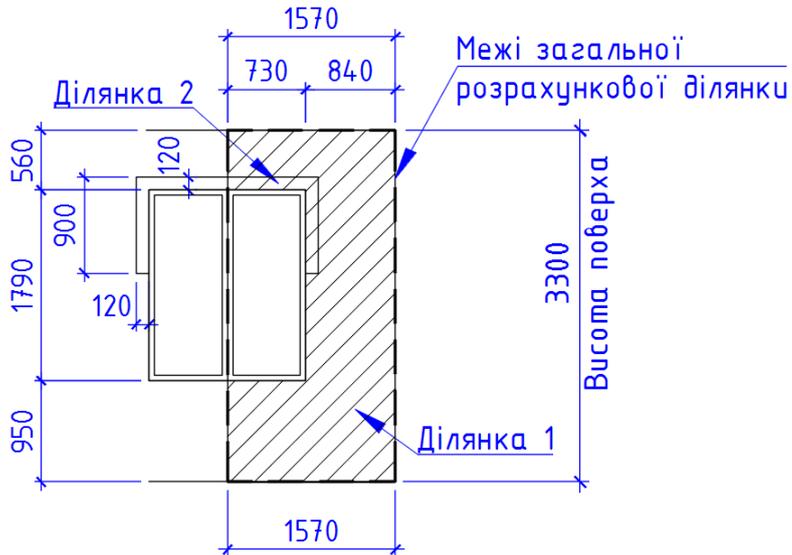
Фрагмент фасаду з розрахунковою ділянкою
